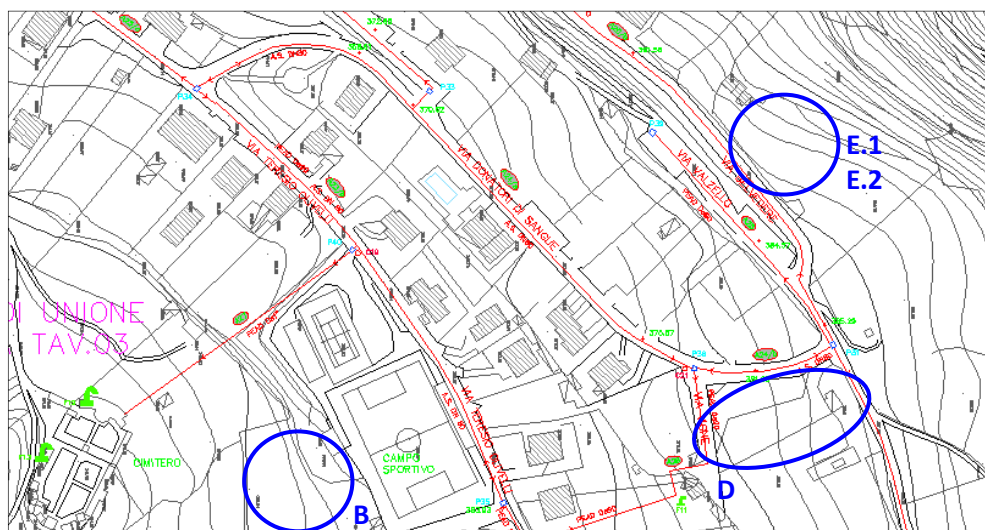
Rete idrica area in variante B, D, E.1, E.2
